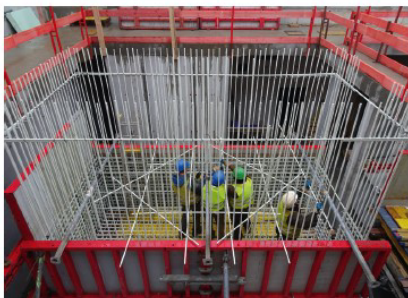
Am ZAQuant der Universität Stuttgart konnten durch die Glasfaserverbundbewehrung Schöck Combar maßgebliche Stützungen ausgestellt durch Stahlbewehrung, vermieden werden
